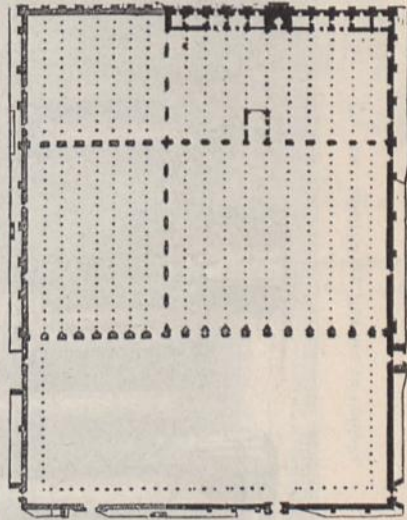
Grundriss der Moschee zu Cordova.
